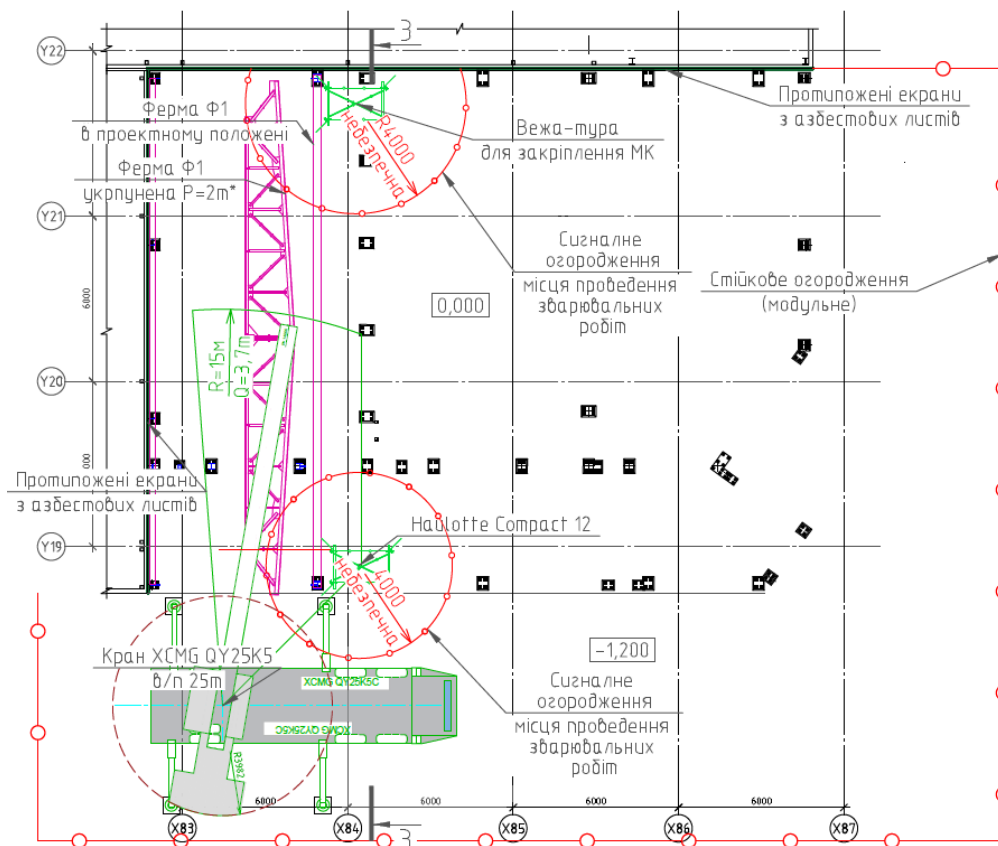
Схема монтажу ферми Ф1 в осях Y19- Y22
